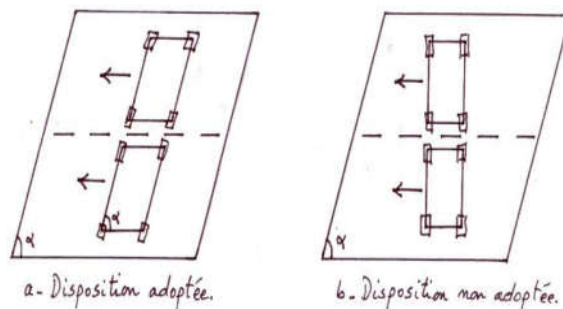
Disposition en plan du système B₁ dans un pont biais
